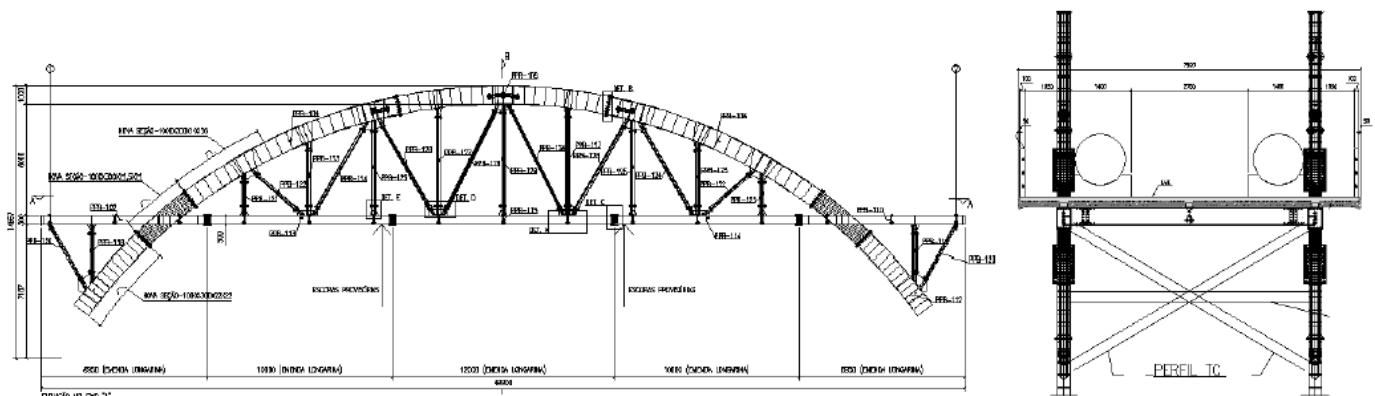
Sistema estrutural da ponte mista em arcos metálicos.
